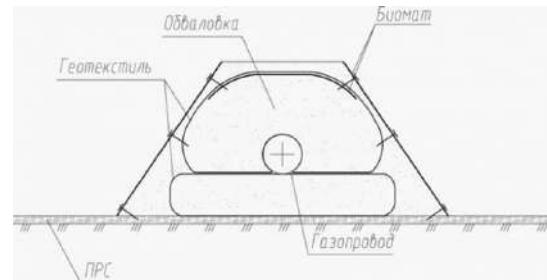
Защита биоматами грунтов обваловок газопроводов наземной прокладки, армированных геотекстильными материалами
